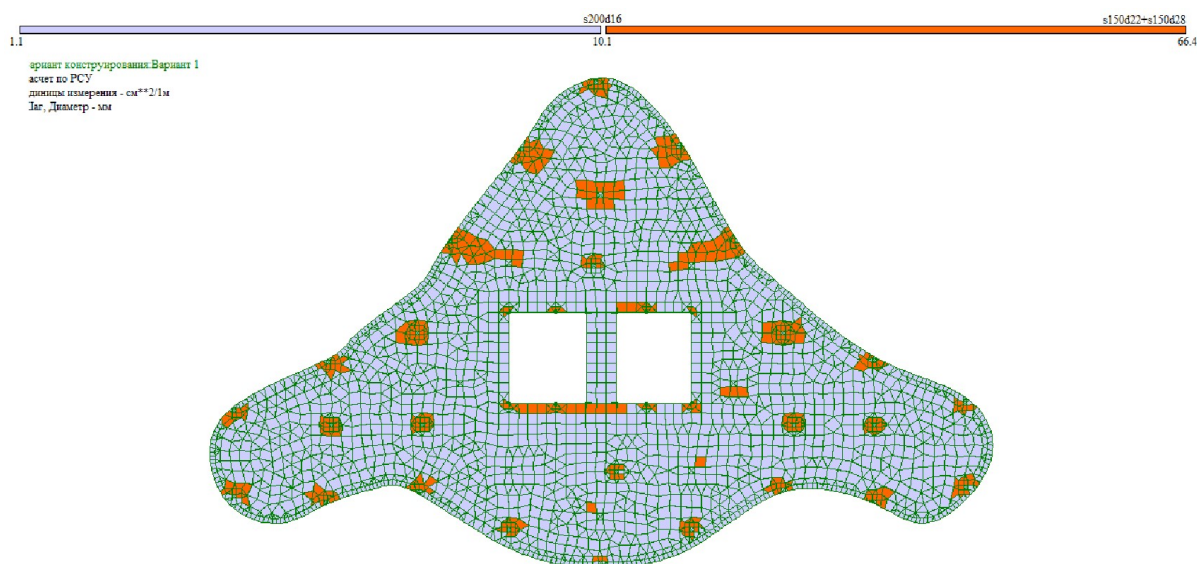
Армирование перекрытия (Верхняя по Y)
